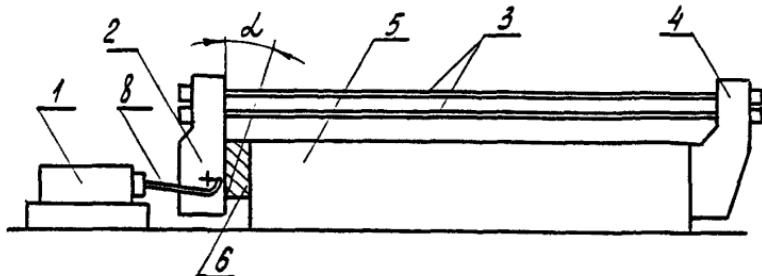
Установка для натяжения арматуры выносными поворотными устройствами (ПО "Моспромжелезобетон")
